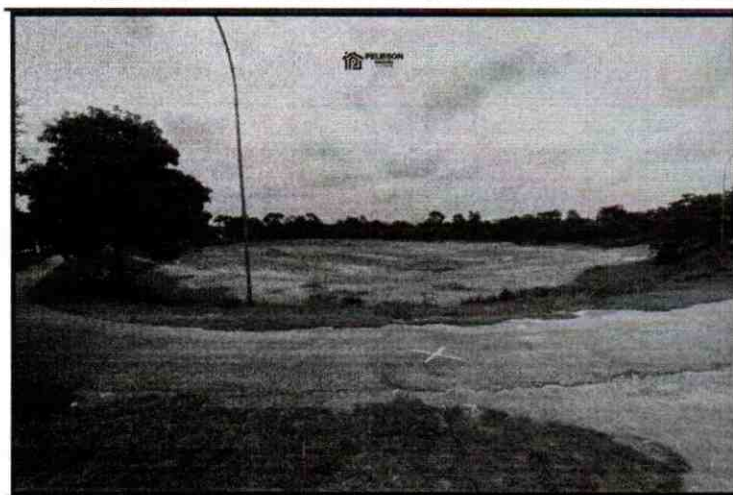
Mostra vista parcial do terreno na cota mais elevada da avenida para fundos
